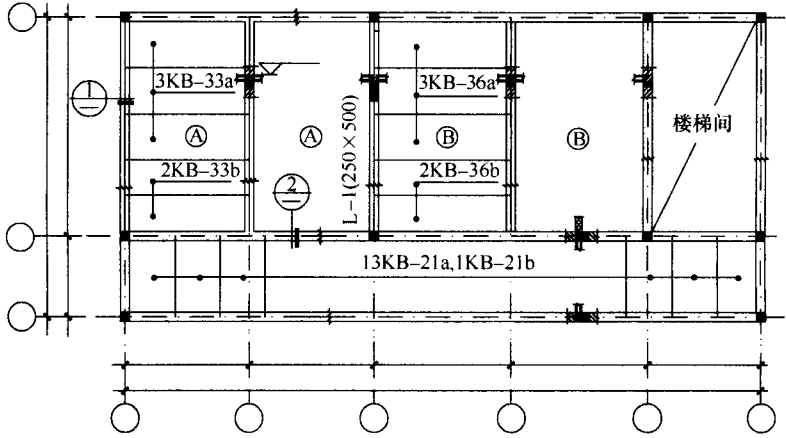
用正投影法绘制预制楼板结构平面图
